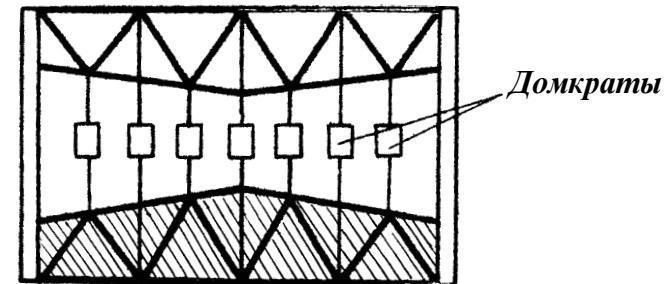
Схема приложения нагрузки при приемочных испытаниях
